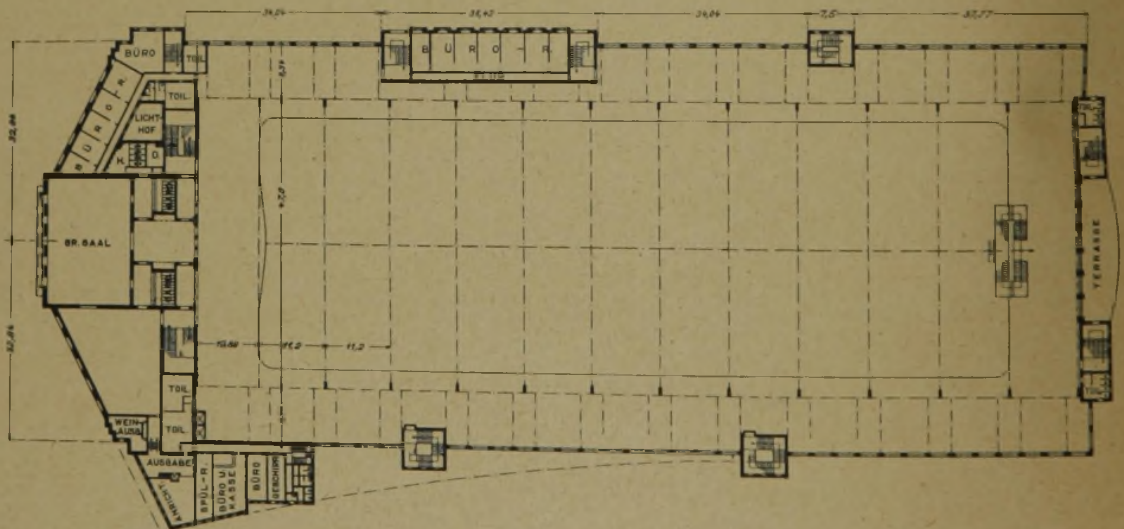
Grundriss der Halle. Galerie-Geschoss. 1:1200.
